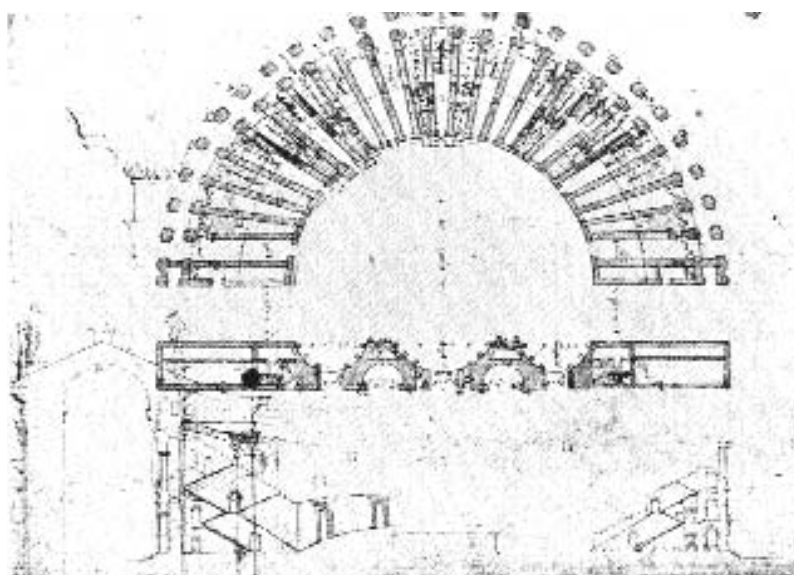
Plan et coupe longitudinale sur la cavea du théâtre Berga
